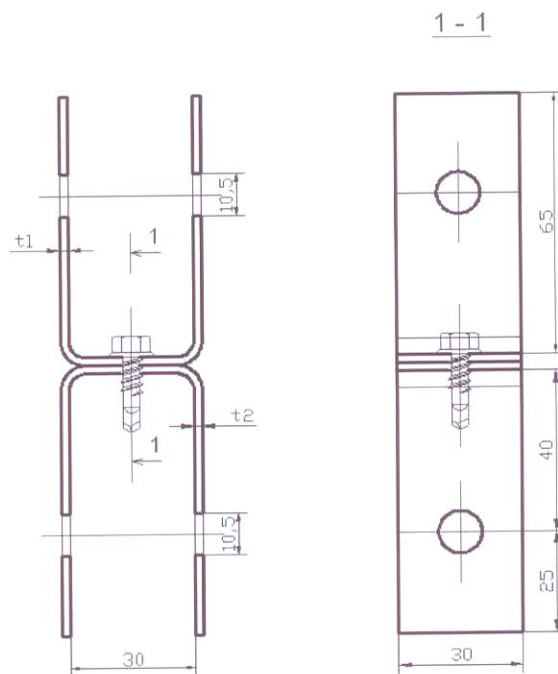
Образец для испытания соединений на растяжение (вырыв винта, отрыв через пресс-шайбу).
